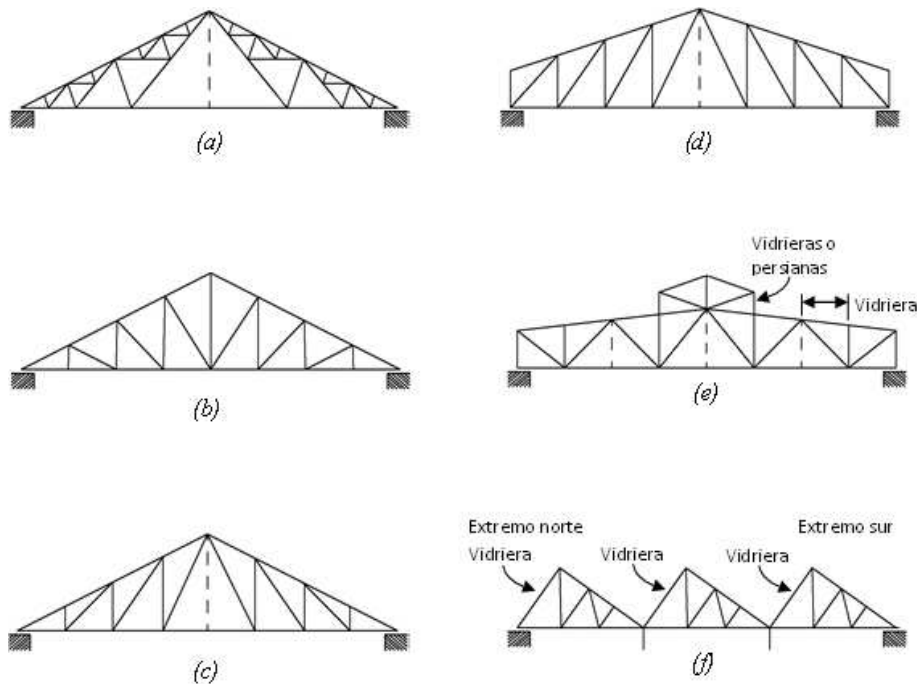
Armaduras de techo: (a) armadura Fink, (b) armadura Howe, (c) y (d) armadura Pratt, (e) armadura Warren con linternilla, y (f) diente de sierra.
